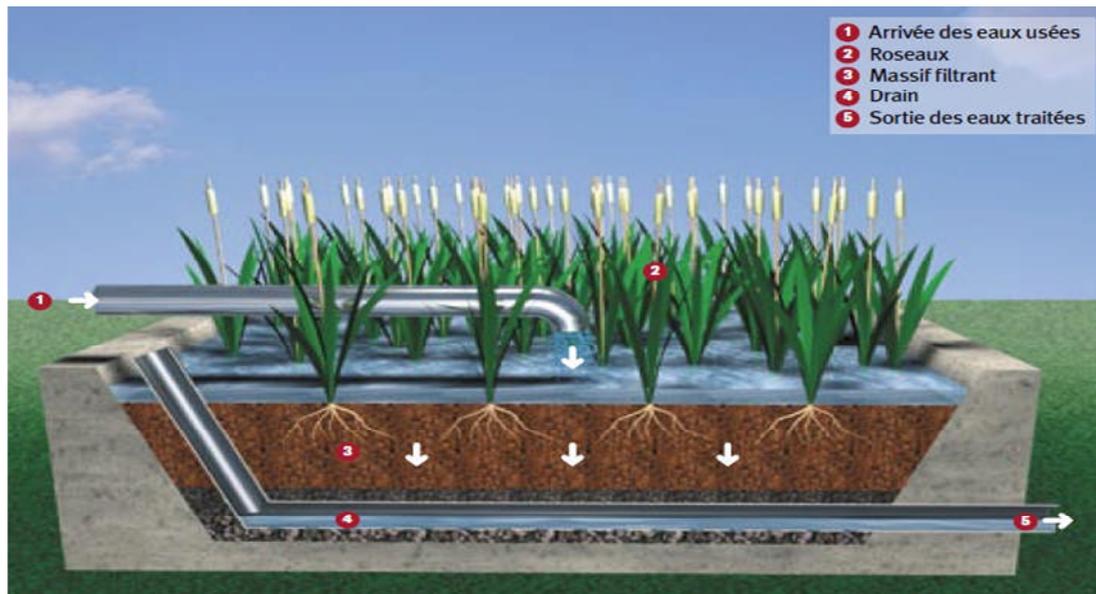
Coupe d'un lit filtrant vertical planté de roseaux.
